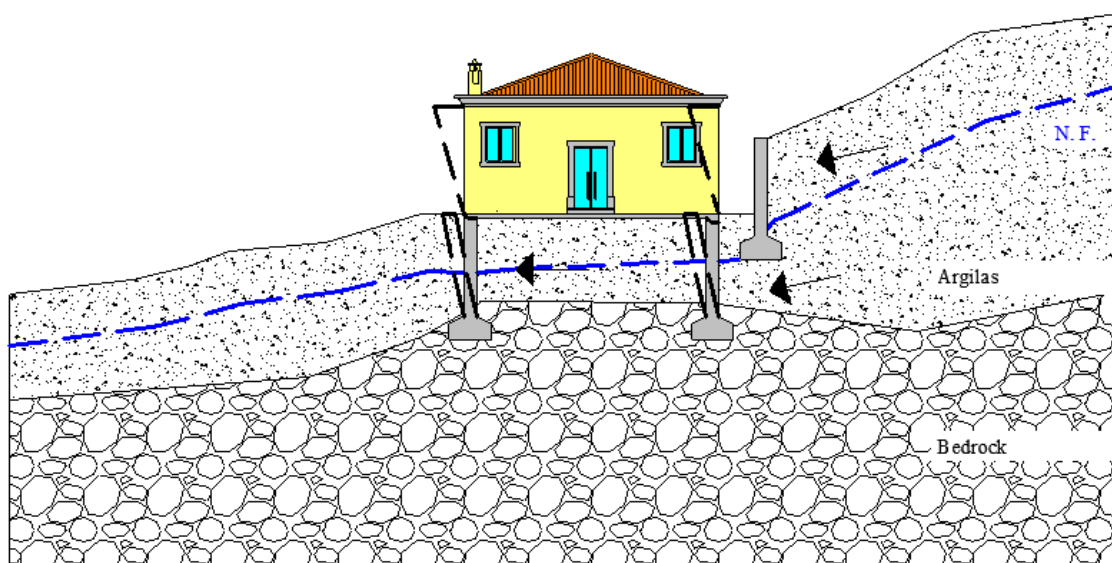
Tipos de fundações presentes na zona afectada em Machico.
